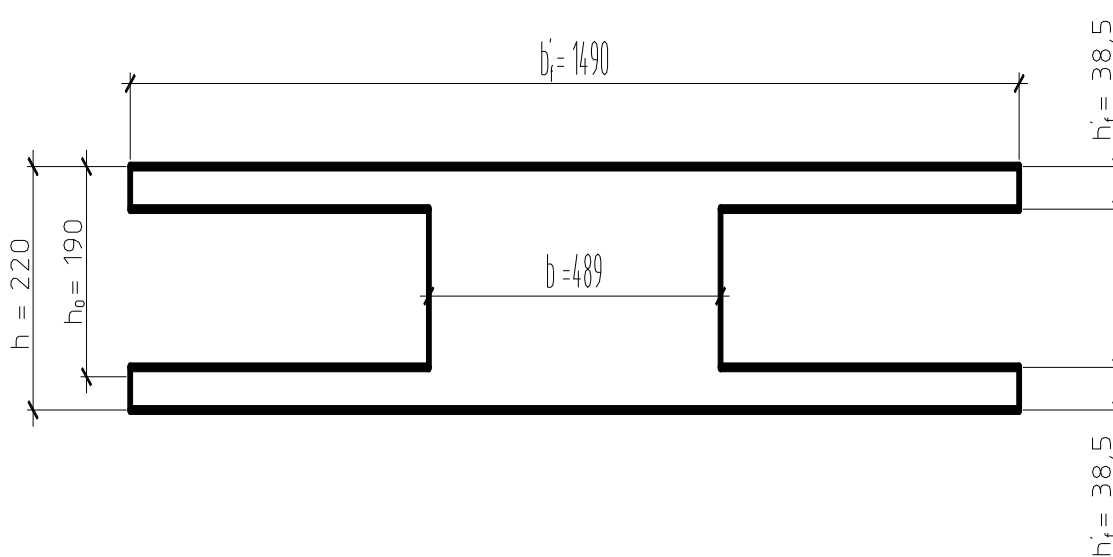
Розрахунковий перетин кругло-пустотної плити перекриття
